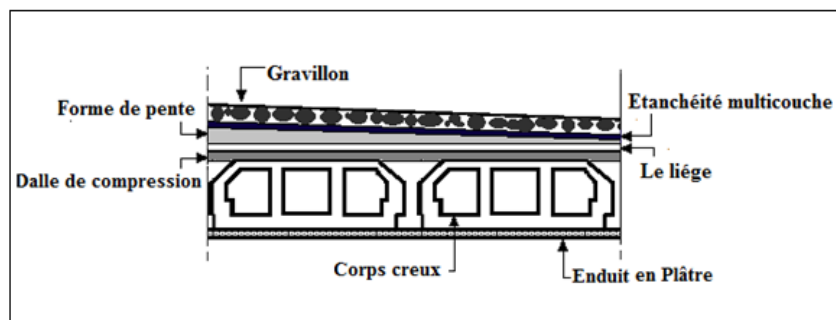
Plancher Corps creux Terrasse inaccessible
